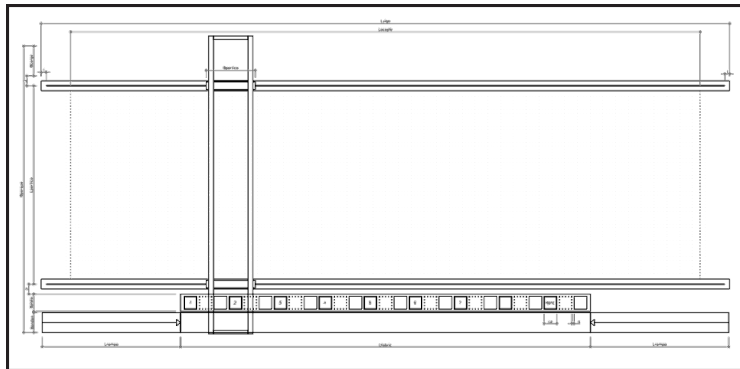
Diseño esquemático en planta de parque intensivo de bloques con puente grúa.
